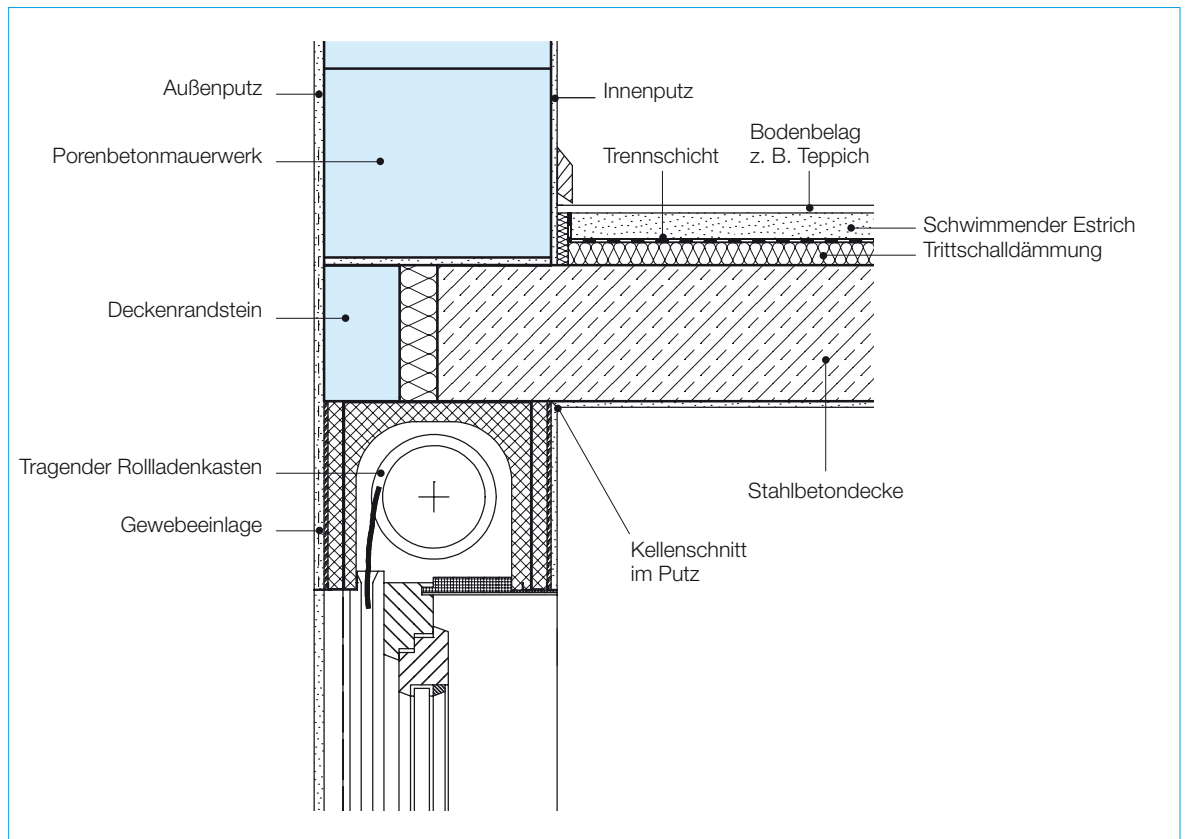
Einschalige Außenwand aus Porenbetonmauerwerk mit Stahlbeton-Geschossdeckenanschluss und tragendem Rollladenkasten
